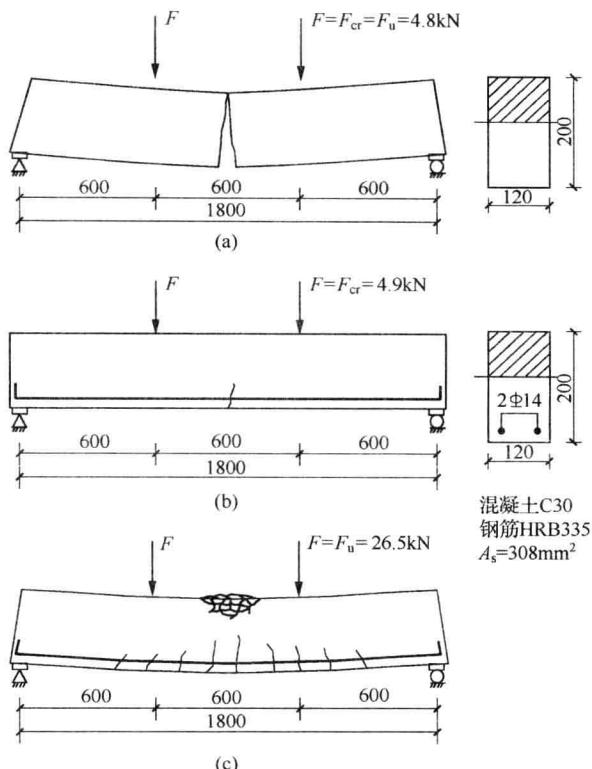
素混凝土梁和钢筋混凝土梁的受力情况
